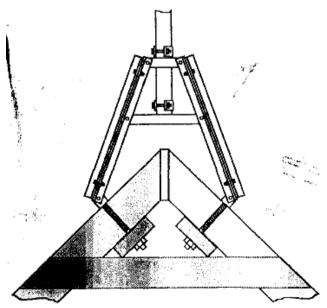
Установка опорного устройства на коньке крыши здания
